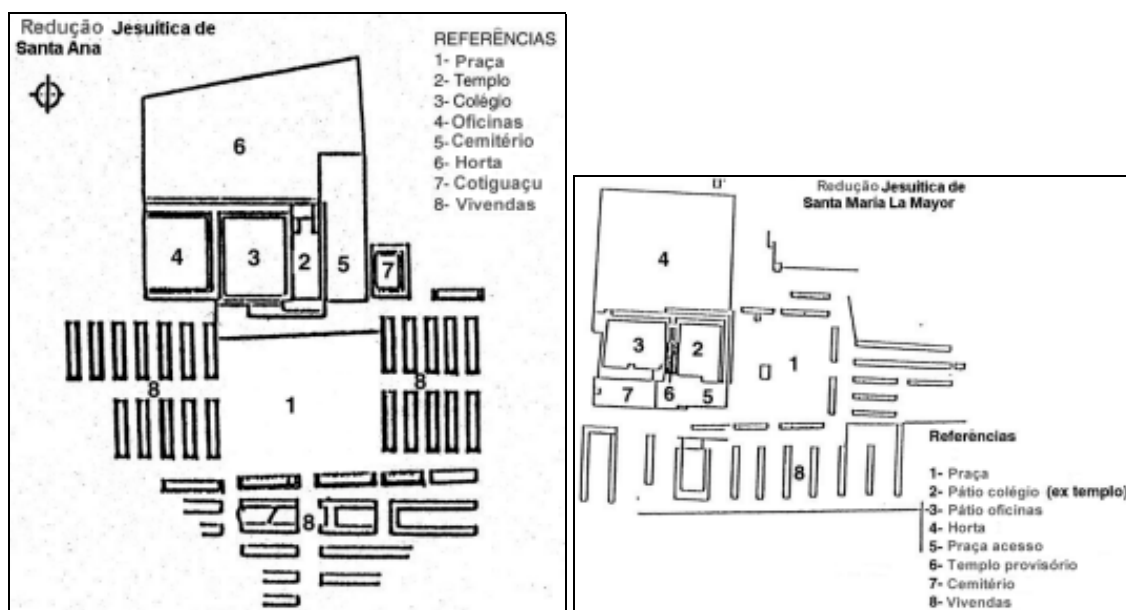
Vista em planta das ruínas de Santa Ana (esq) e Santa María (dir).
